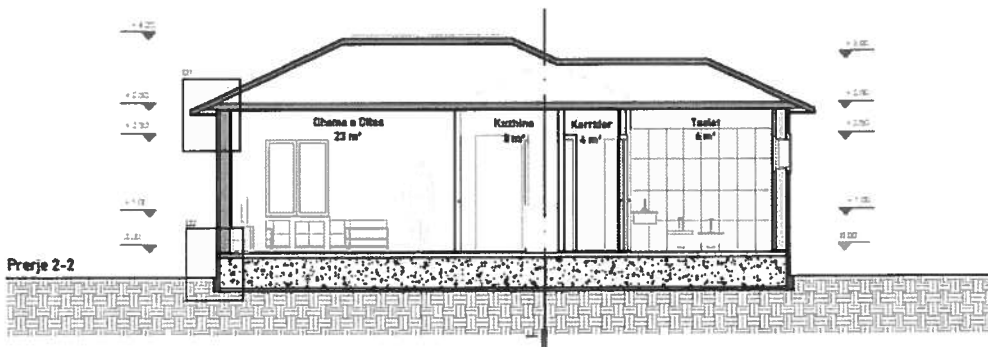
Planimetria e ndërtesave tip 2+1
